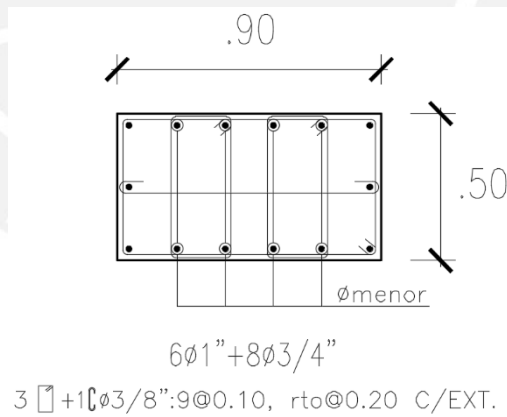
Disposición final en planta del acero en la columna C-02.
